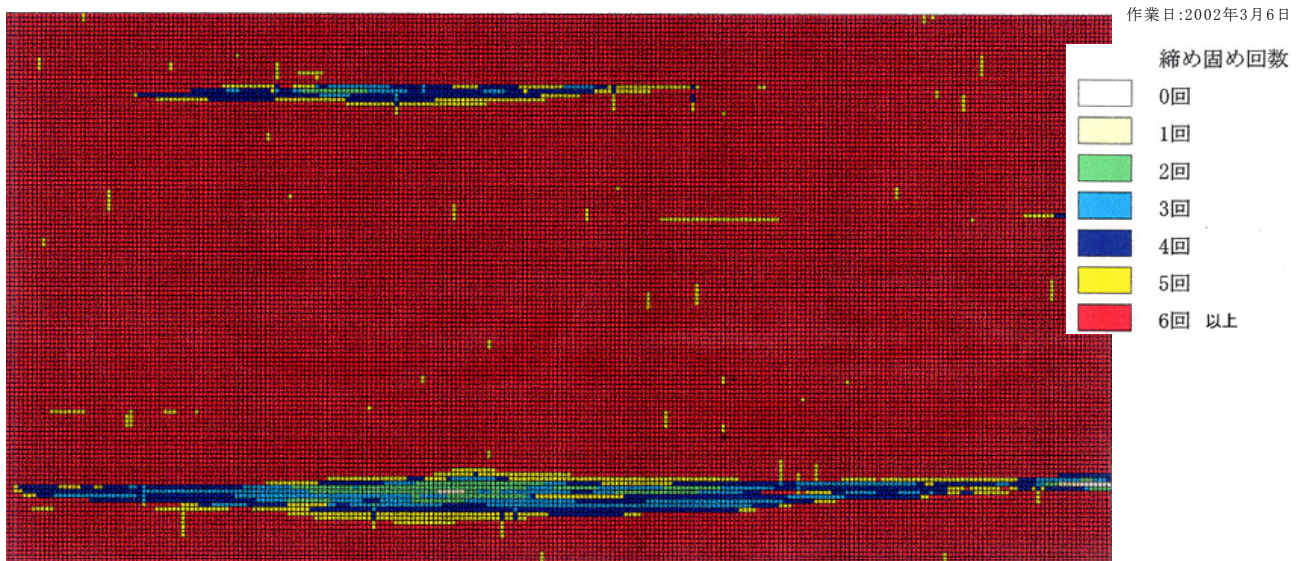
2 従来施工とシステム施工箇所の締固め度比較
